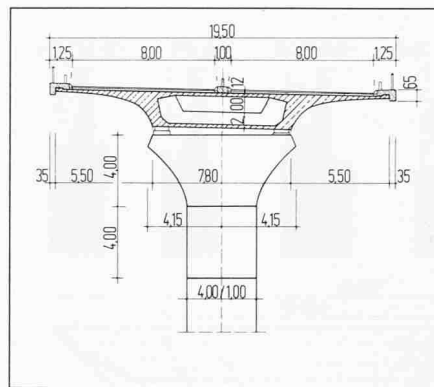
Brückenquerschnitt der Hochstrasse Wien - Nussdorf
